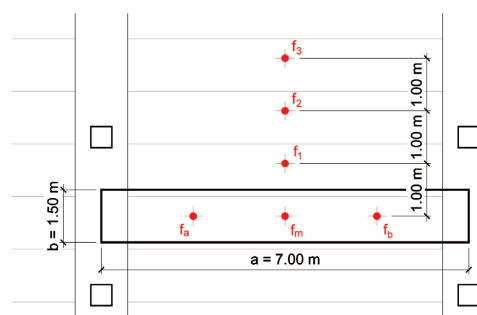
Schema di posa in pianta del carico. Diagram of layout of the load.
